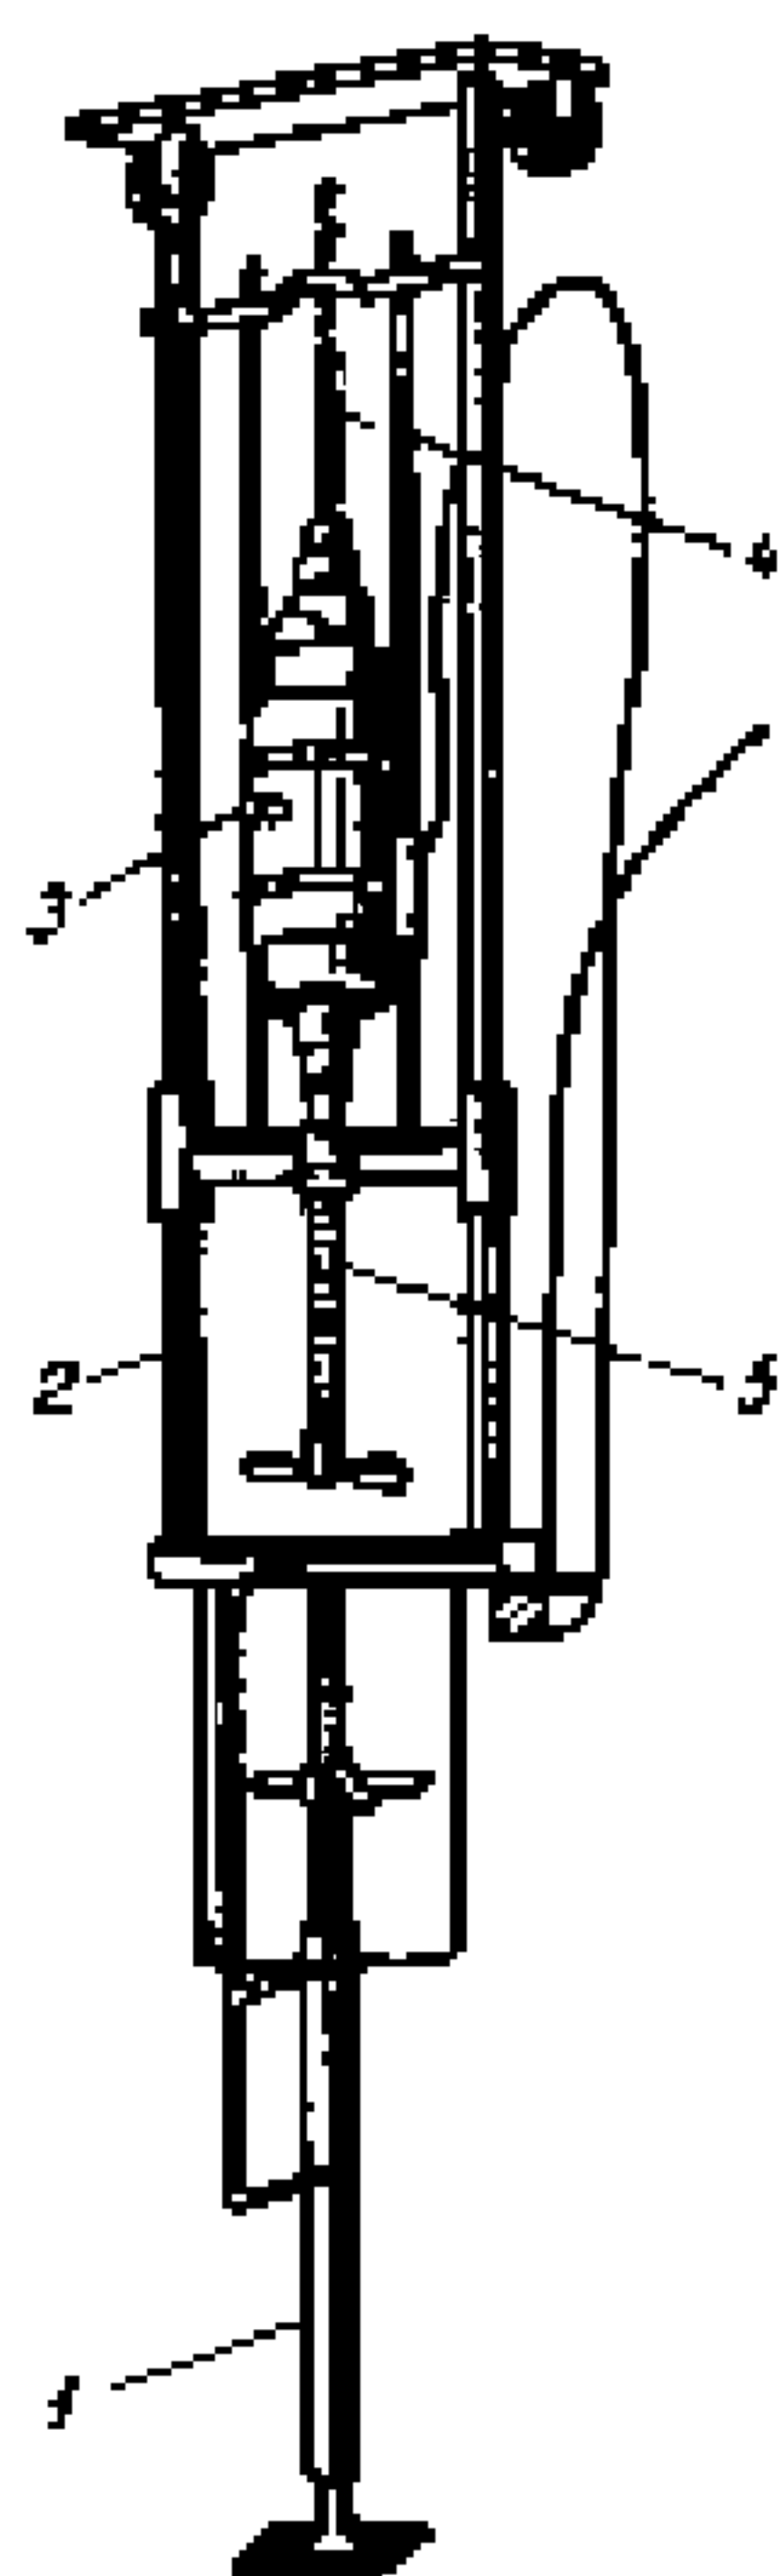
Устройство для создания давления на сверло при сверлении отверстий в стенах и перекрытиях
